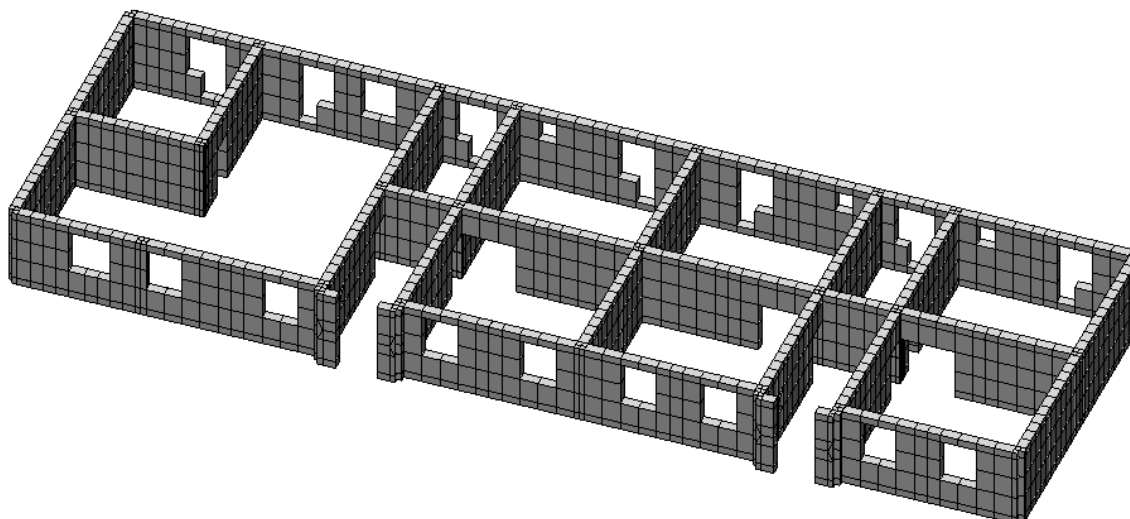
Схема расположения несущих кирпичных стен этажа здания
